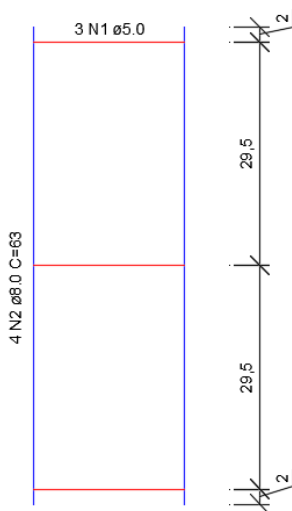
Detalhe da armação do pilar 2 (Referência). Fonte: Autor, 2017.
